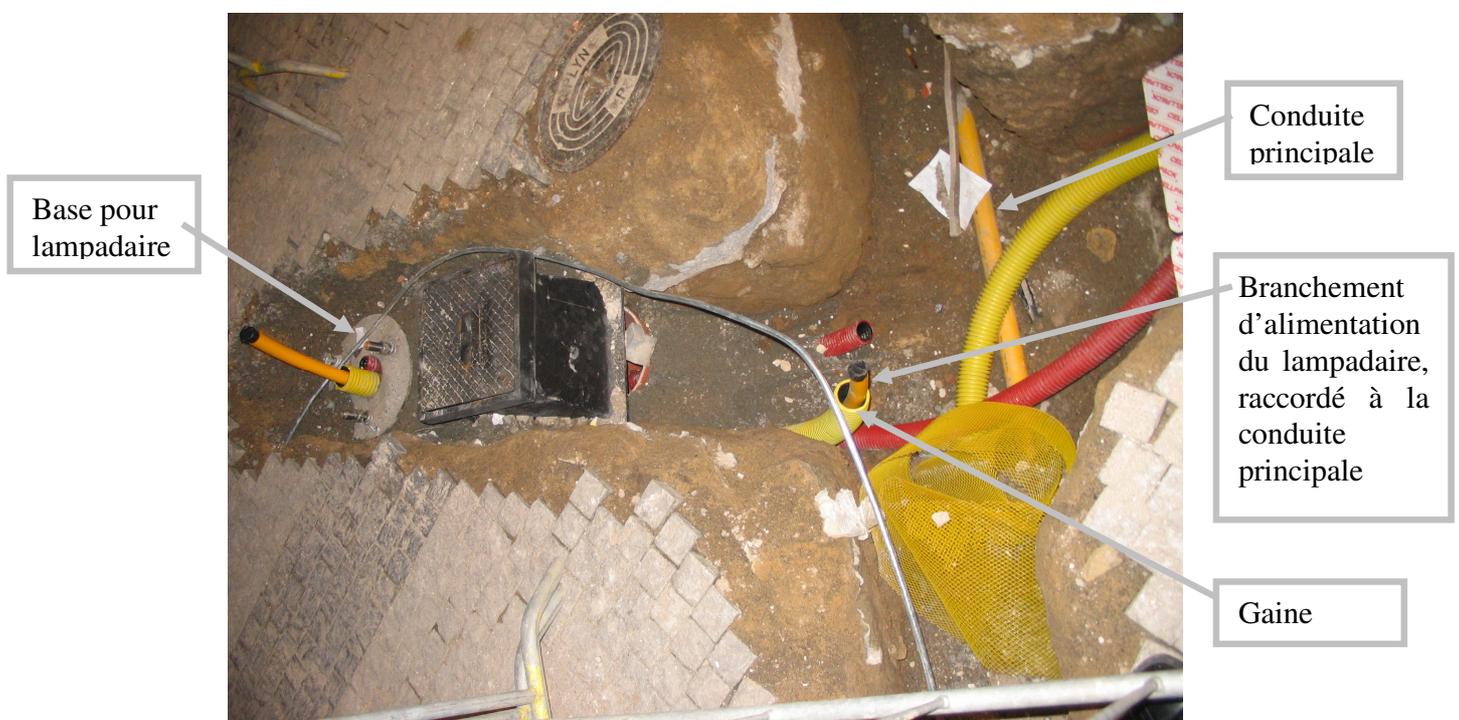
Conduite de gaz en pleine terre pour l'alimentation d'un lampadaire, Prague
